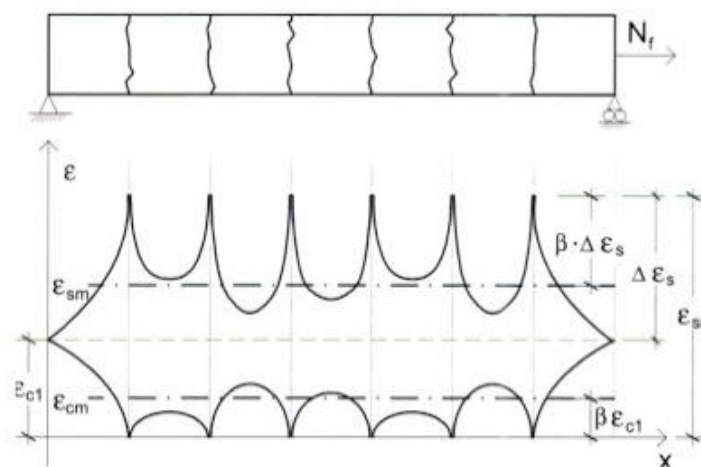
Última fissura i fissuració estabilitzada [1]
